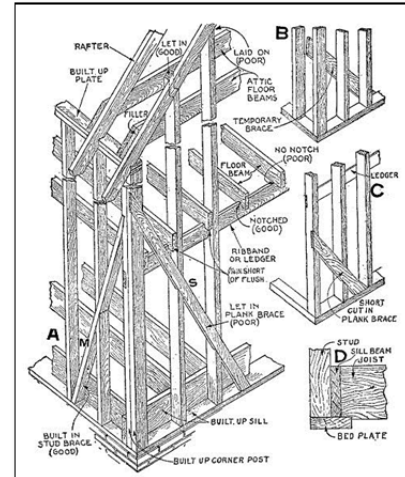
Drawing showing the layout of wood in a balloon framed house.
